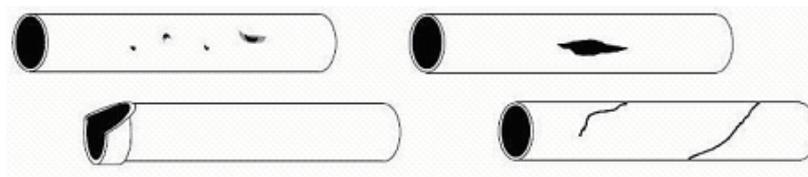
Exemplos de fissuras e fraturas em tubos.
